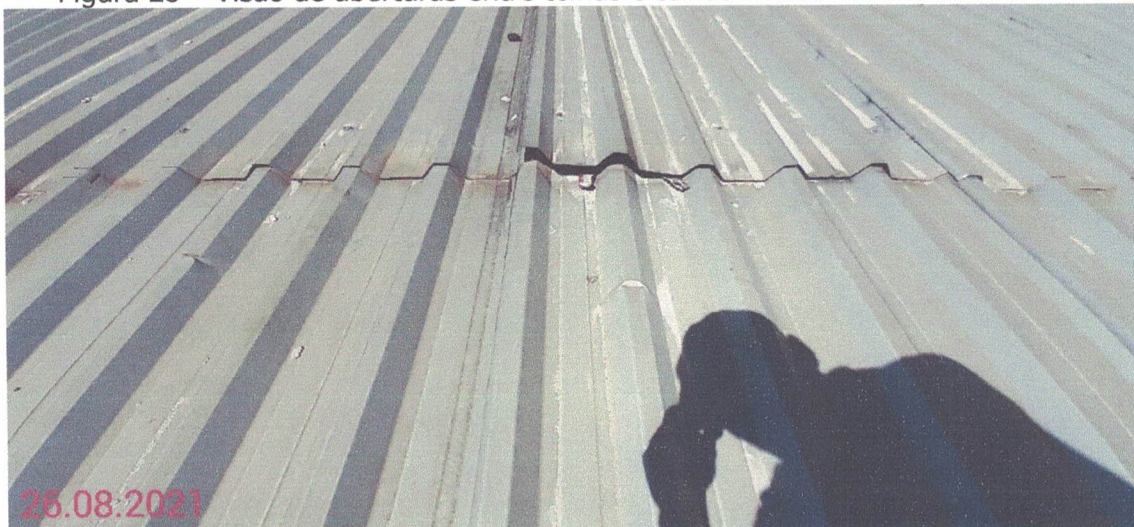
Visão de aberturas entre telhas e telhas amassadas.
